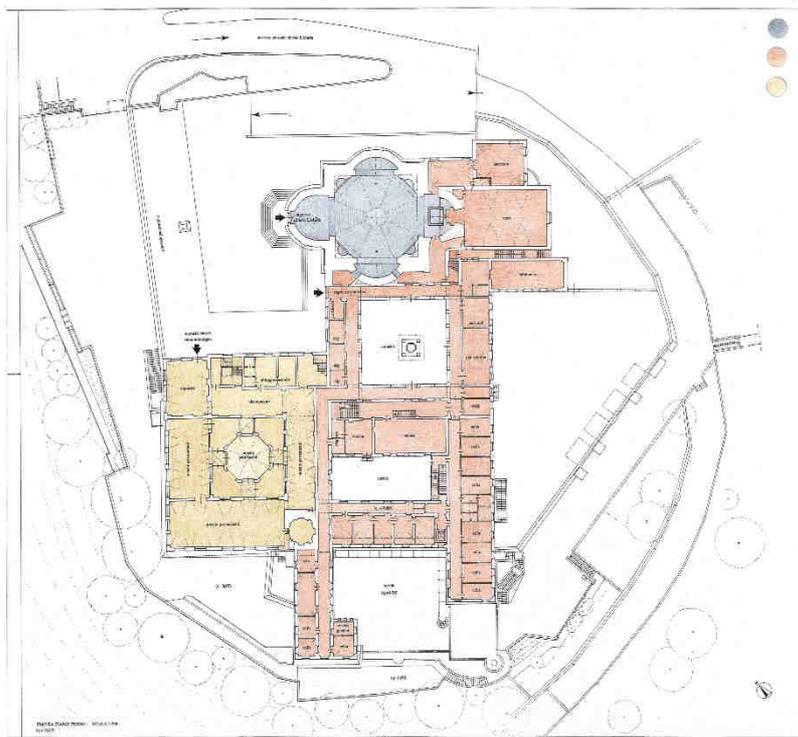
Pianta piano terreno (piazzale); in rosso i locali del convento
